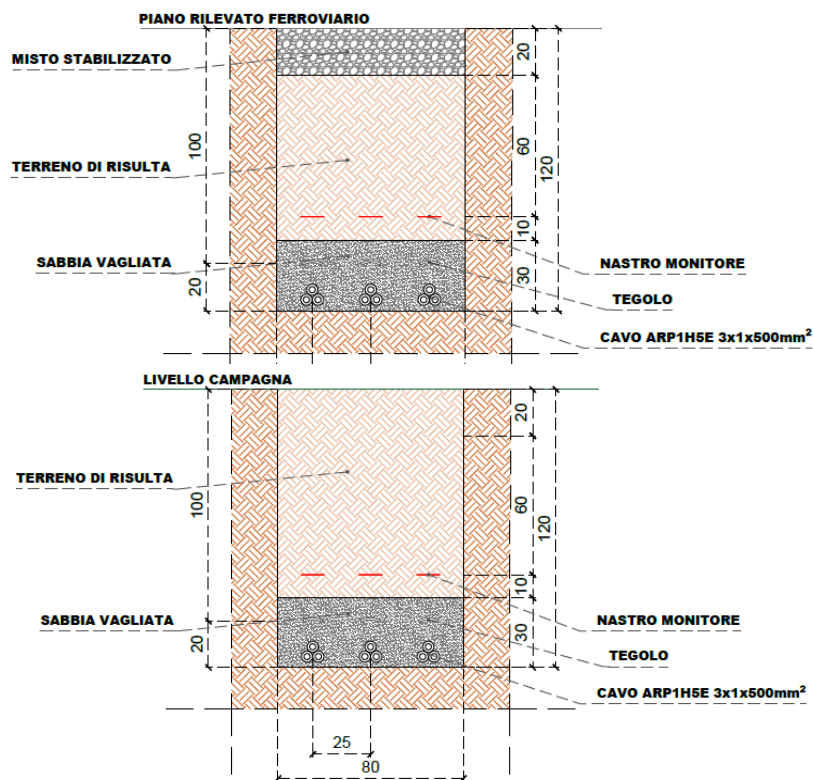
Dettaglio sezioni di scavo per posa cavidotto MT
